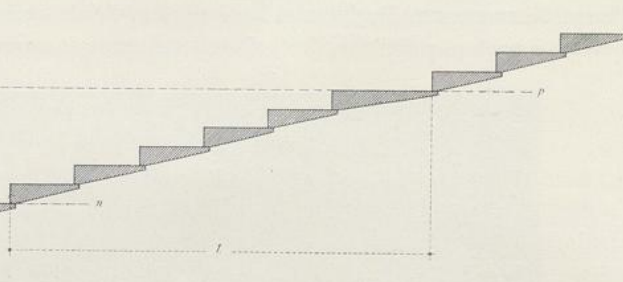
a. Abgewickelter Schnitt entlang der Umfassung.
